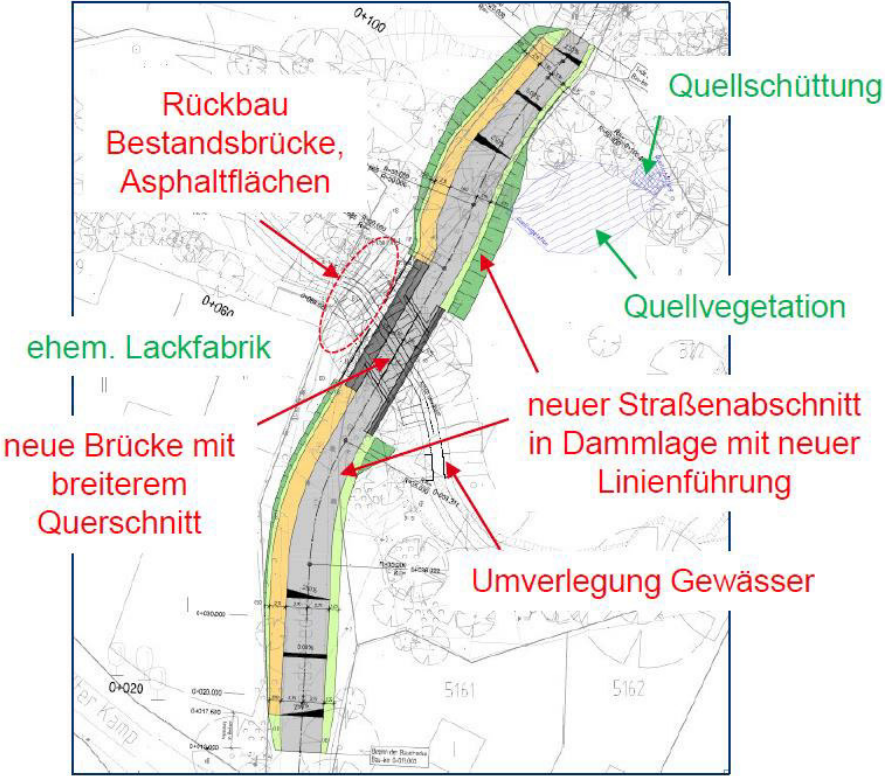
Lageplan des Bauvorhabens zum Brückenneubau und zur Gewässersanierung im Bereich Wandseredder (Auszug LSBG 2021)
